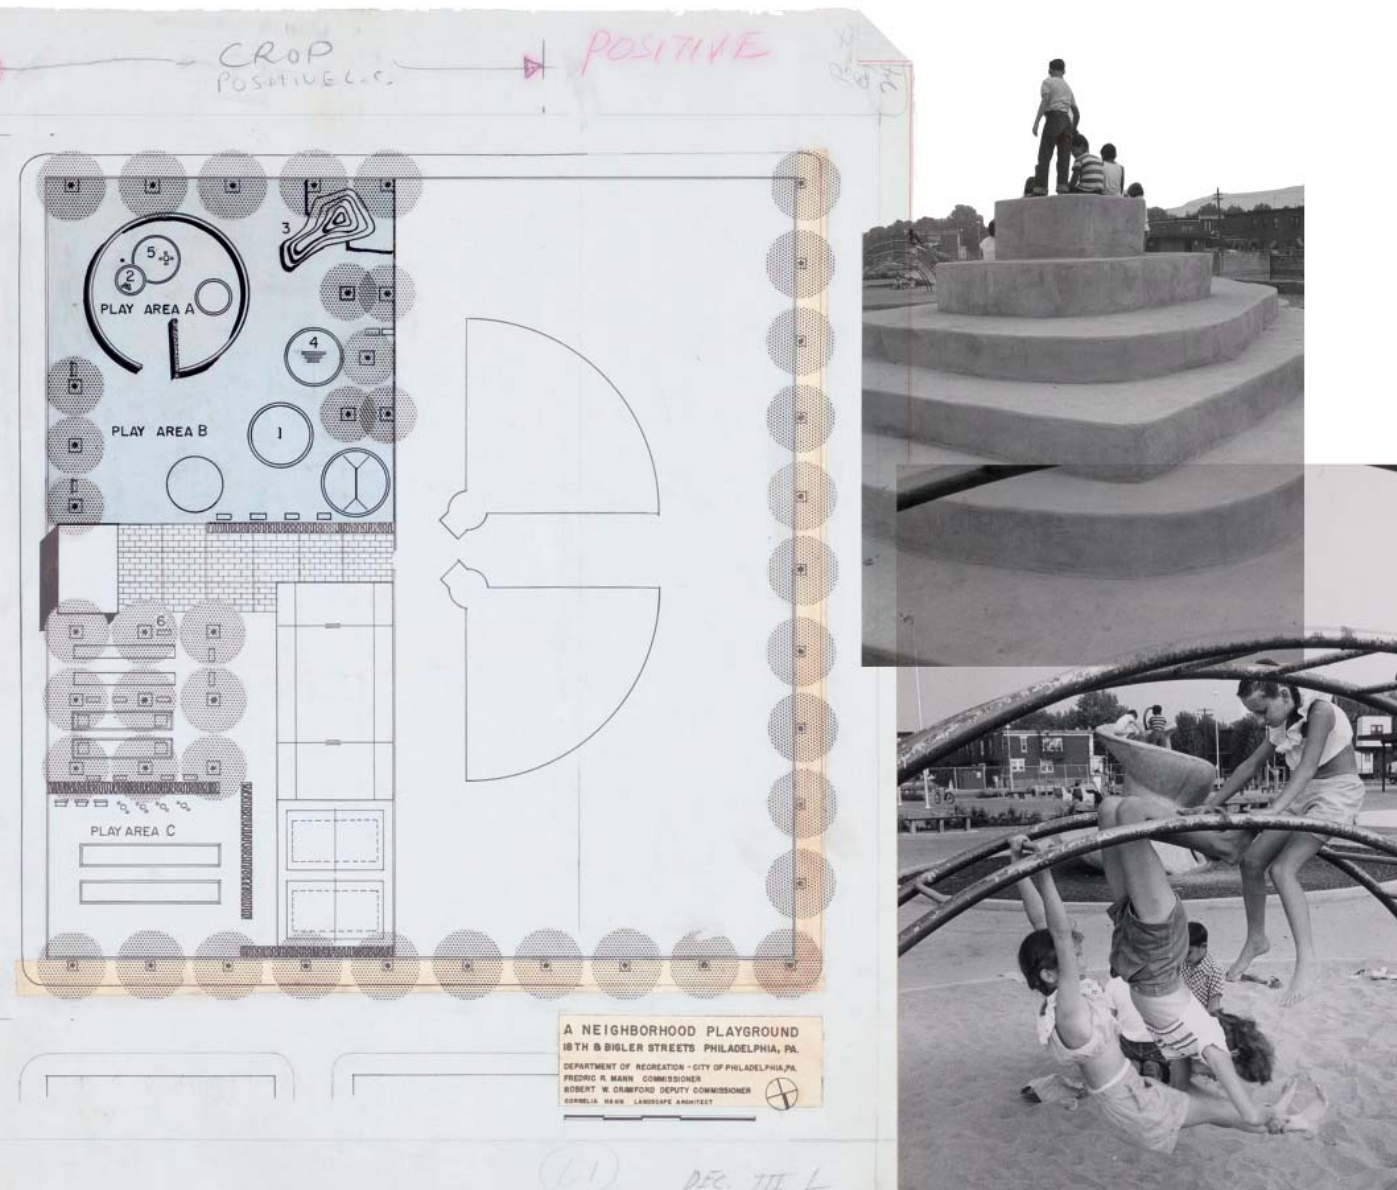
Planta e imágenes del parque situado entre las calles 18 y Bigler en Filadelfia.
